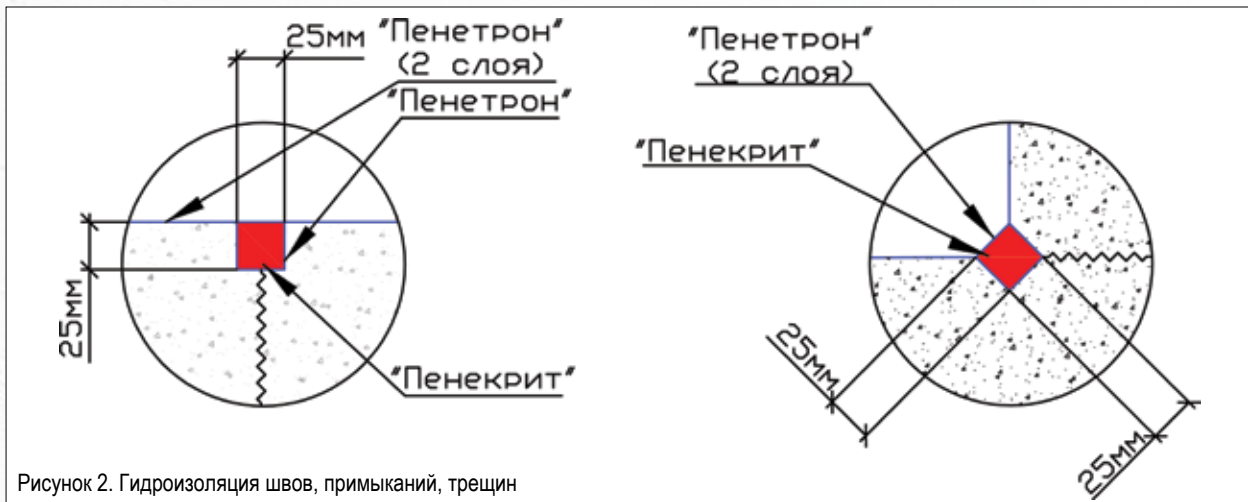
Гидроизоляция швов, примыканий, трещин
